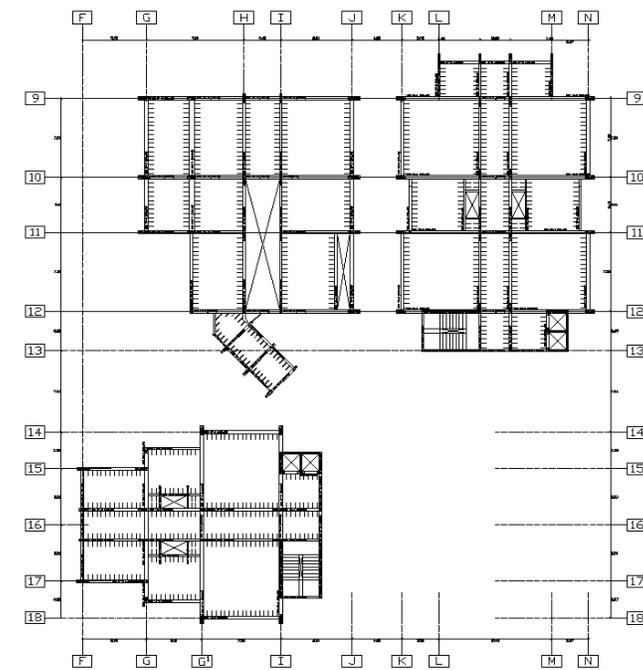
Plano de encofrado de primer piso sector 1. Fuente Elaboración propia
